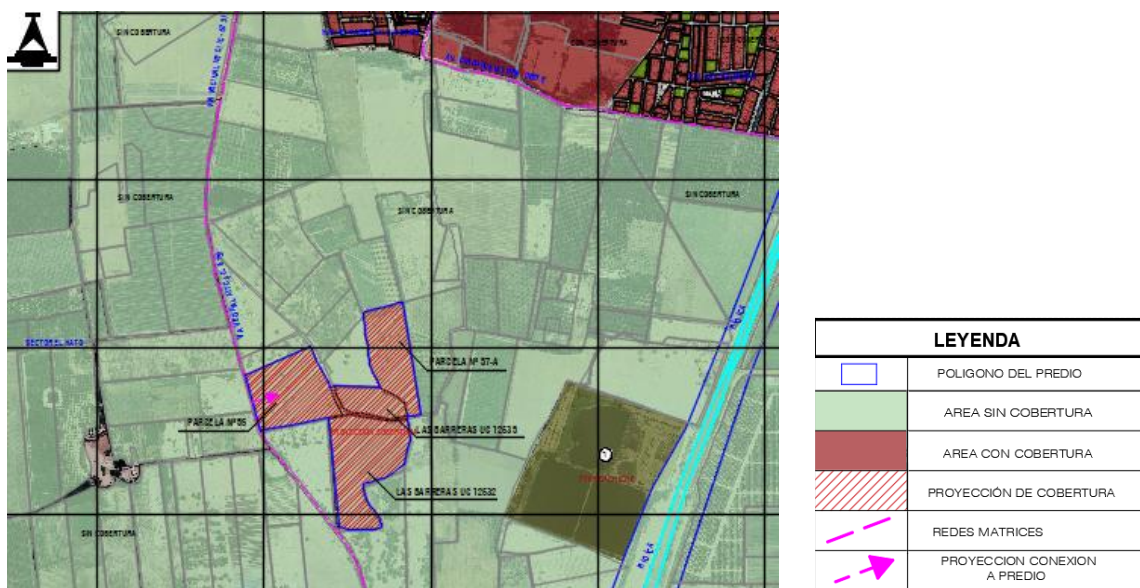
Plano de Cobertura de desagüe, ver plano PI-08.
